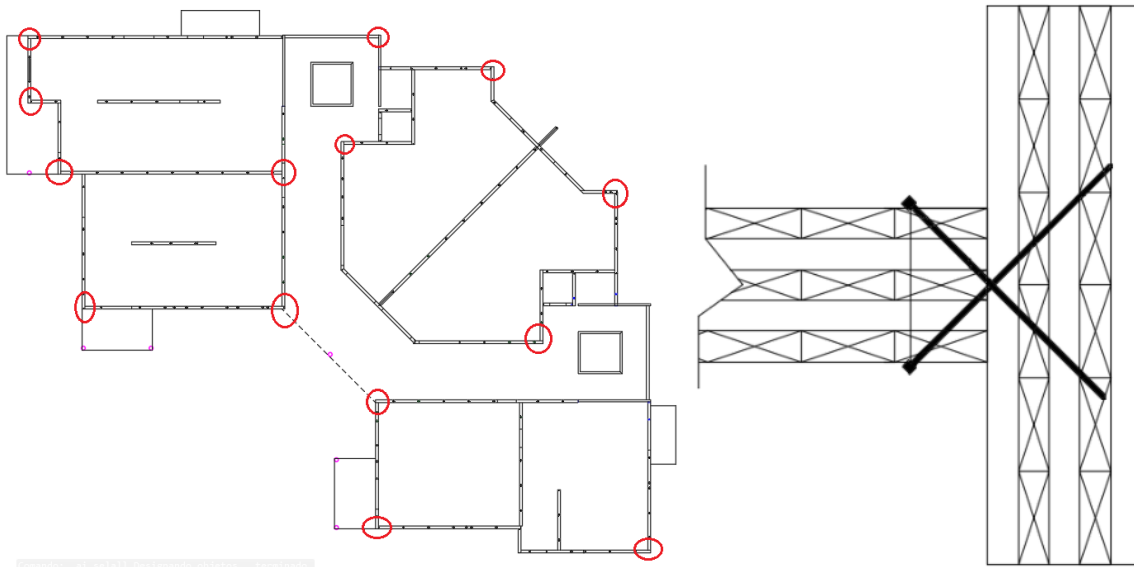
Caracterización unión muro – muro perpendicular.
